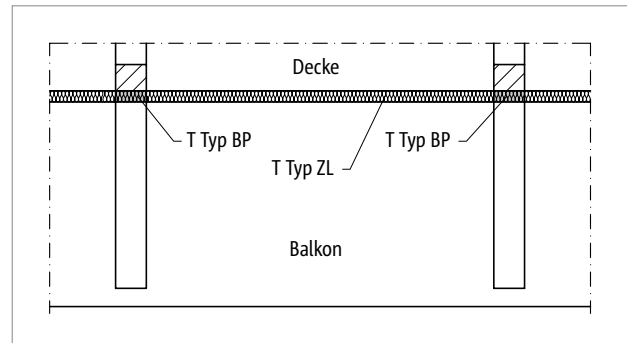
Schöck Isokorb® T Typ BP: Balkonkonstruktion mit frei auskragenden Unterzügen
